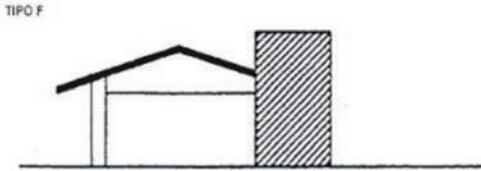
Esquema de configuración edificio-defensa tipo F.
